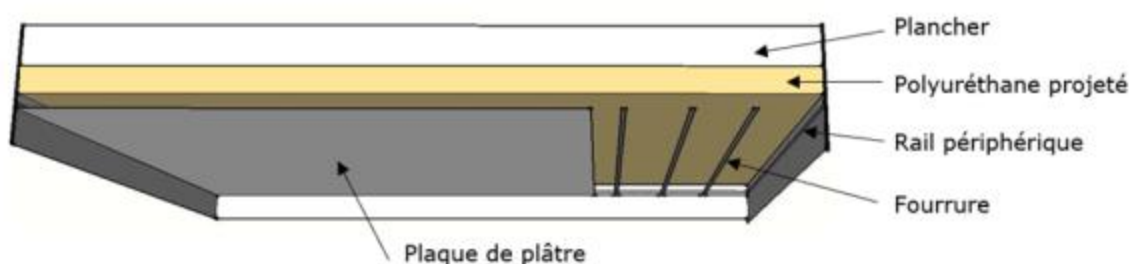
Plafond constitué de fourrures simples ou doubles sans dispositif de suspension au support
